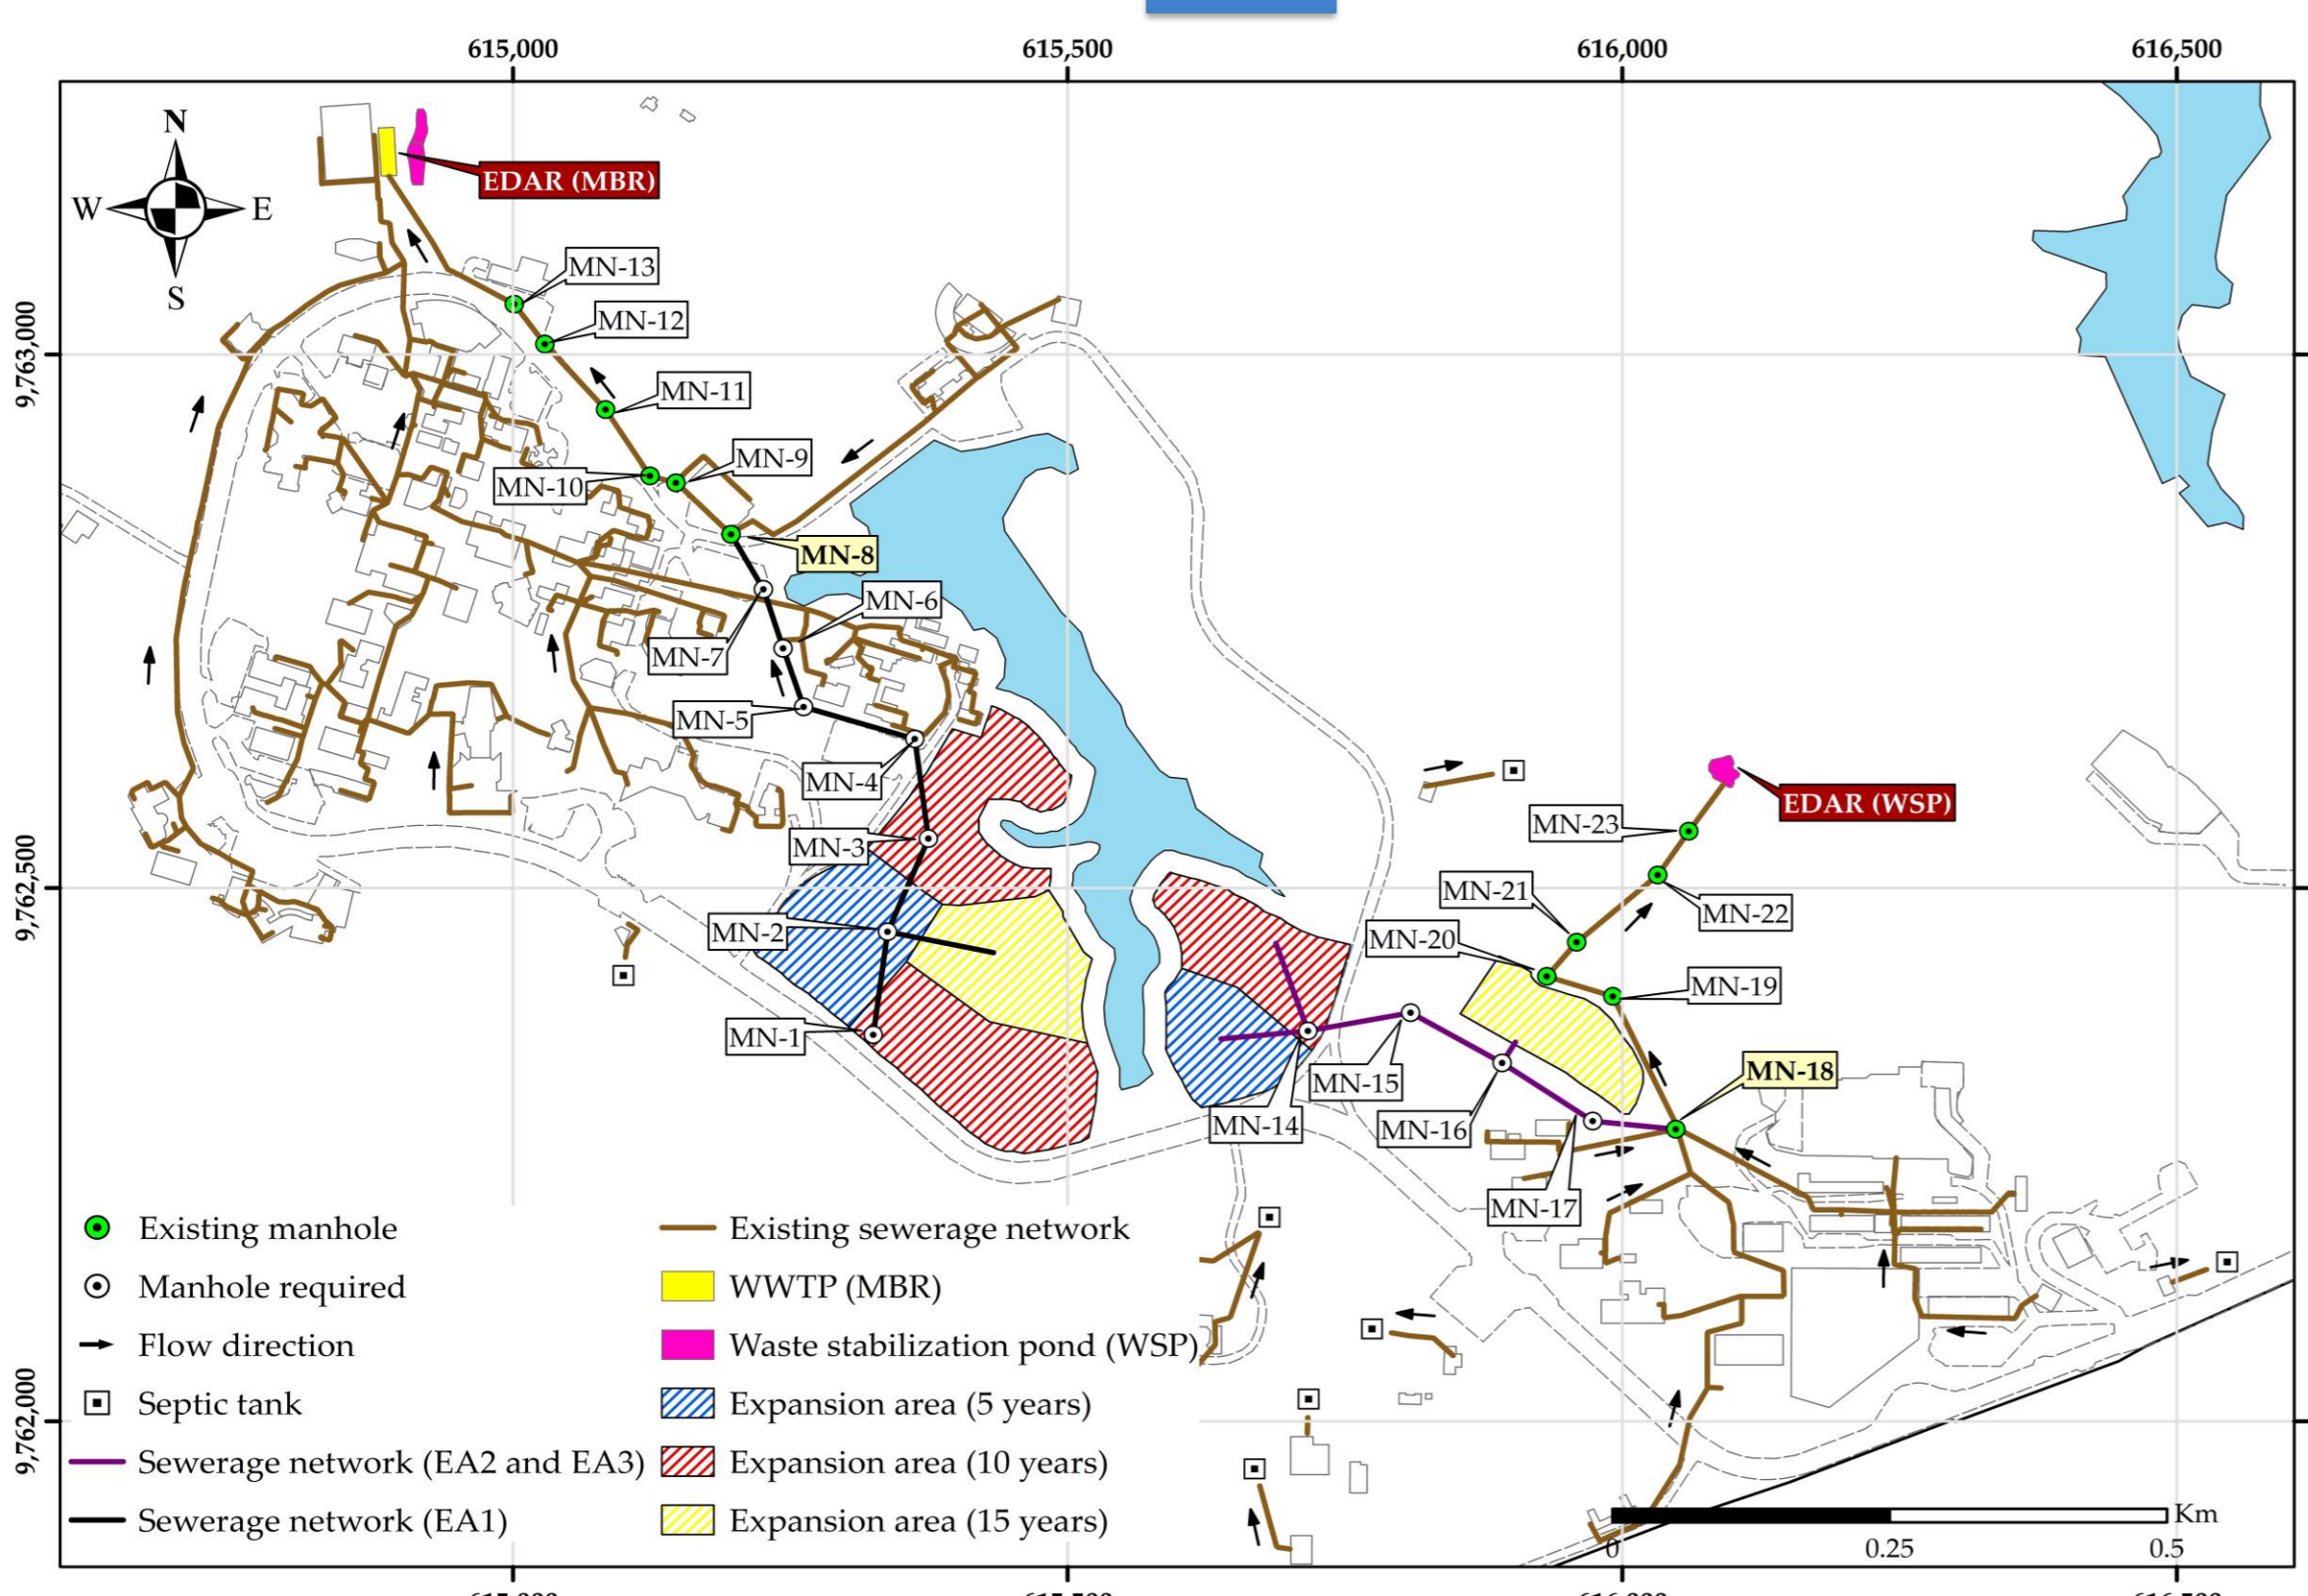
Sistema de alcantarillado para las zonas de expansión 1, 2 y 3.
